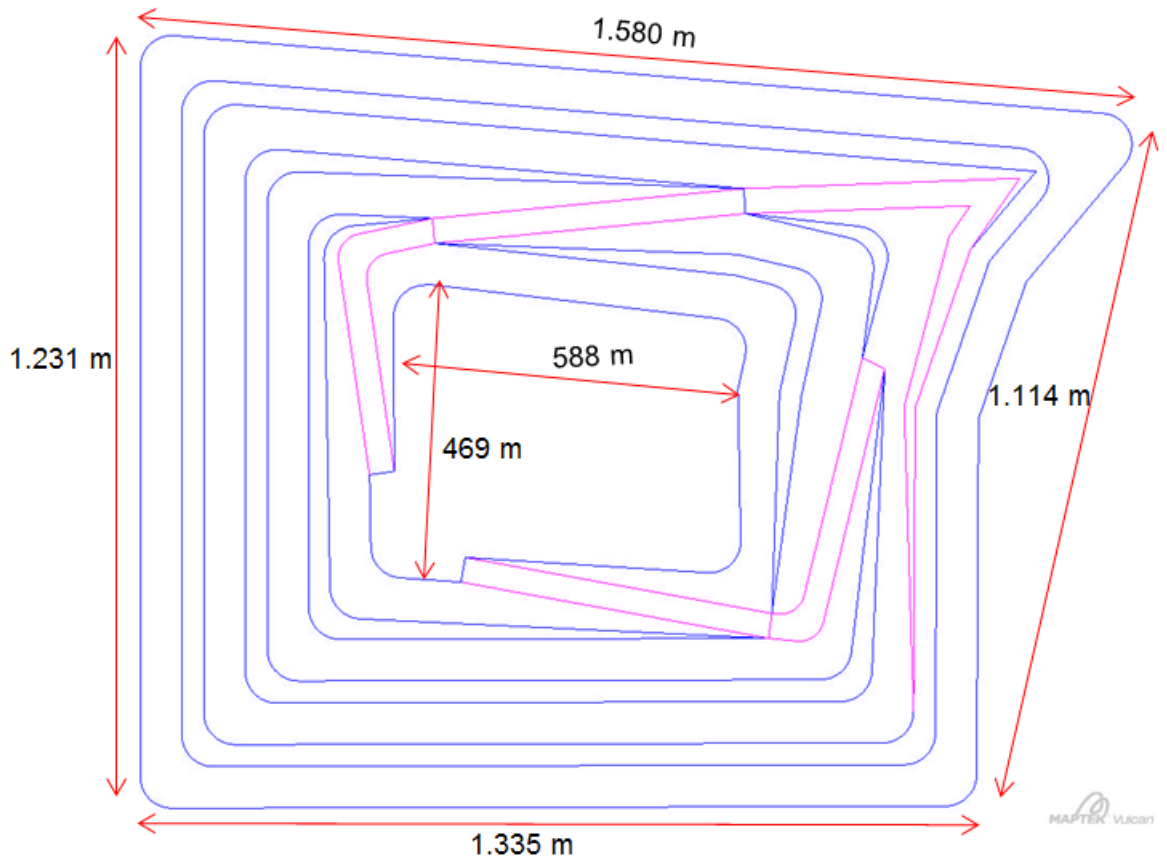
Vista en planta botadero oeste alternativa 3.
